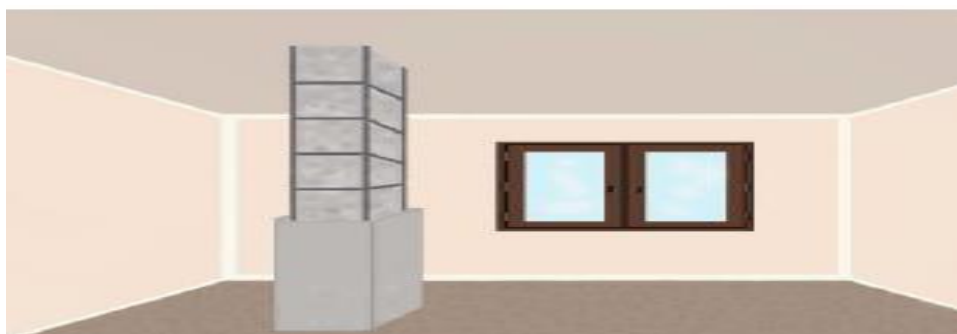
Retiro del recubrimiento de la columna para reforzar (*Fuente:* Silva 2014)
